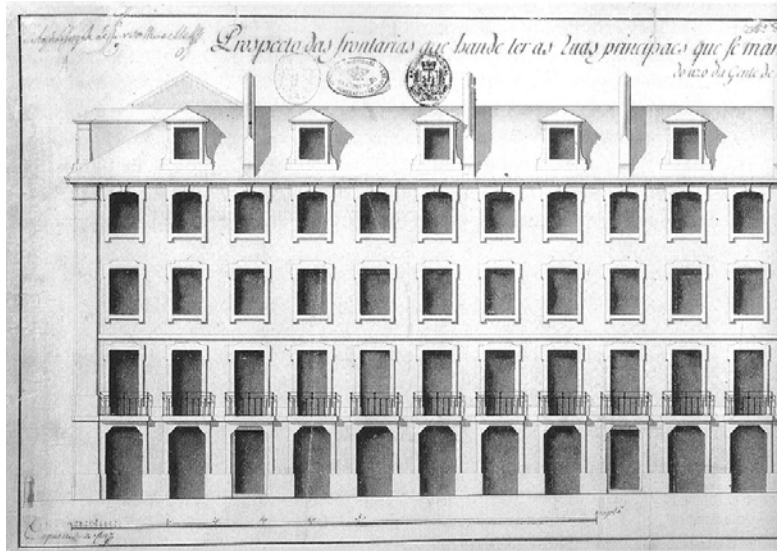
Proposta para fachadas de edifícios da Baixa – Eugénio dos Santos [4]
